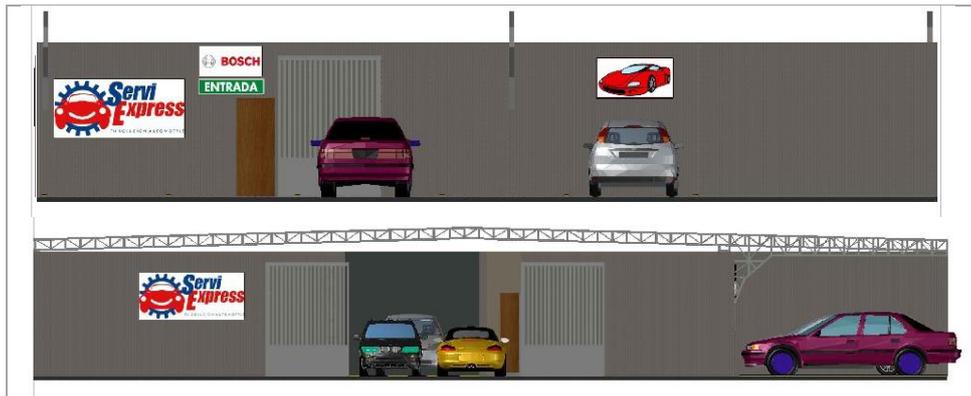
Vista frontal y lateral taller en AutoCAD 3D
